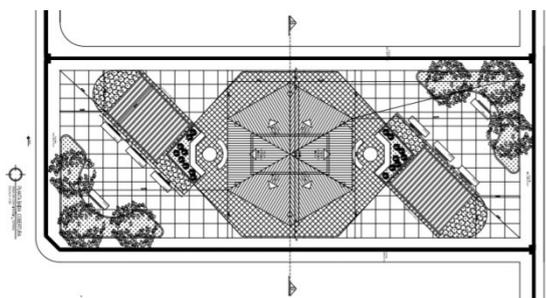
Planta baixa: Cobertura da Área de Convivência do CETENS.
